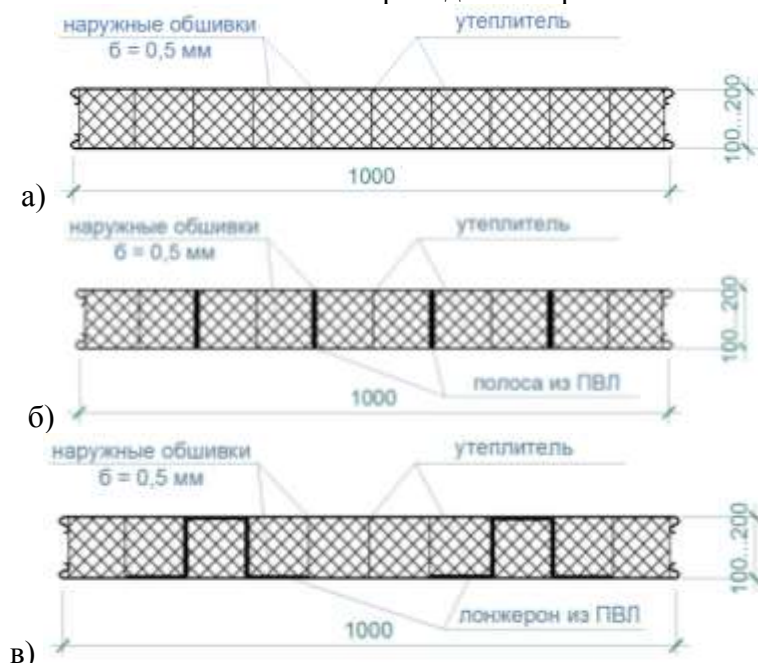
Поперечное сечение рассматриваемых сэндвич-панелей: а) традиционной; б) с армирующей полосой из ПВЛ; в) с армирующим лонжероном из ПВЛ.
